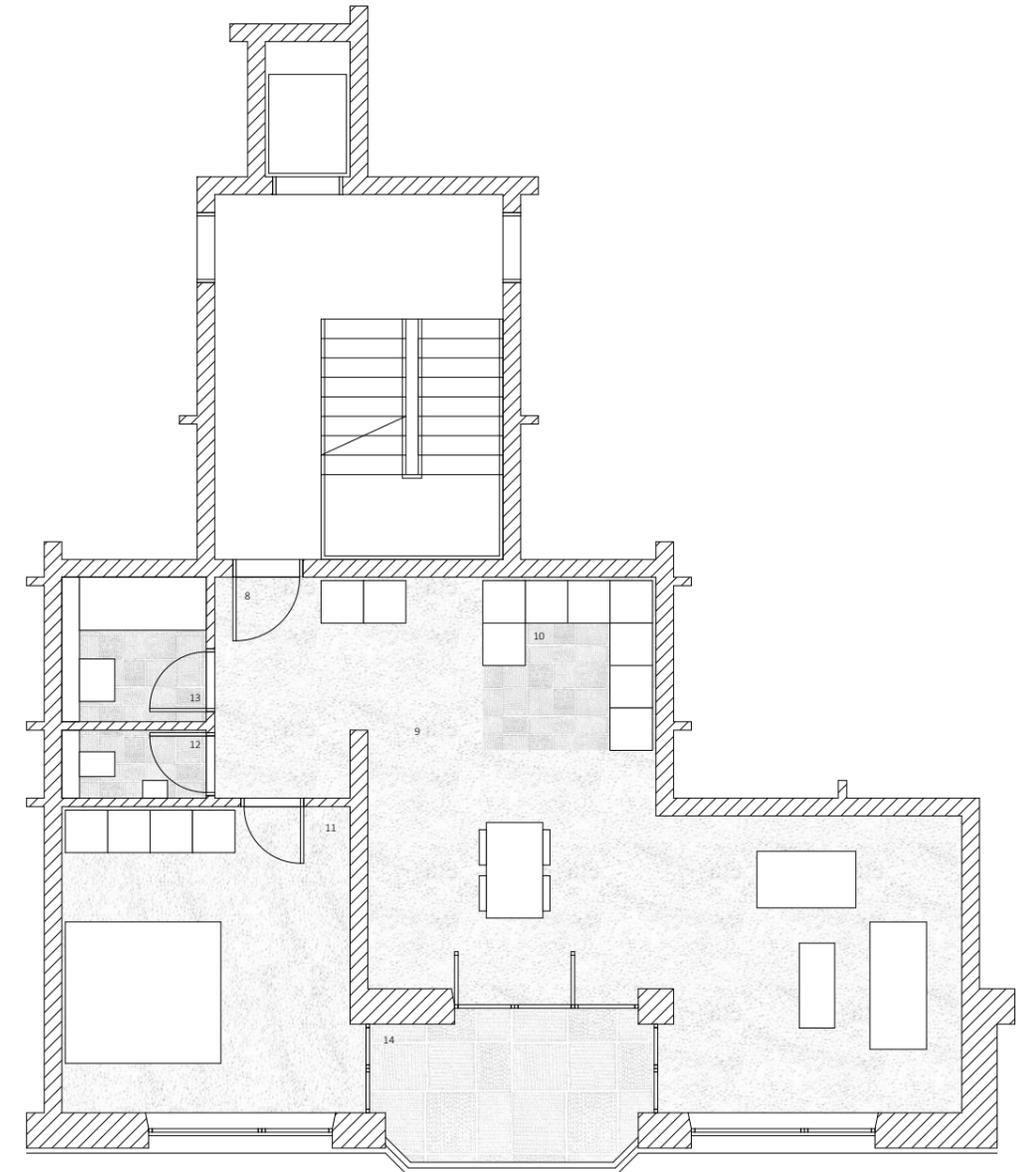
Grundriss Wohnung 2/Stiege 3
